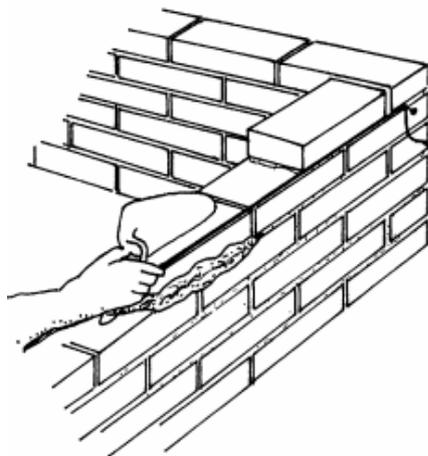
Assentamento do tijolo. Fonte: (MILITO)
